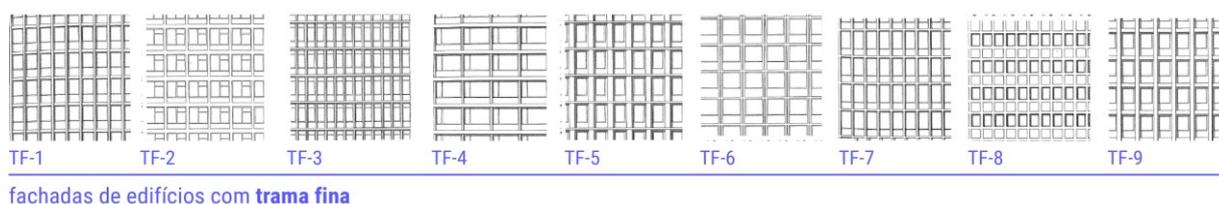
Formas estruturais visíveis em fachadas de edifícios com trama fina
